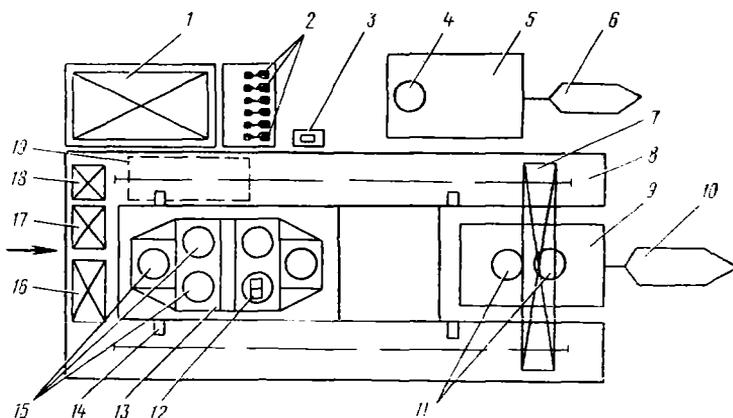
Платц расположения оборудования и механизмов при погружении оболочек в русле реки:
